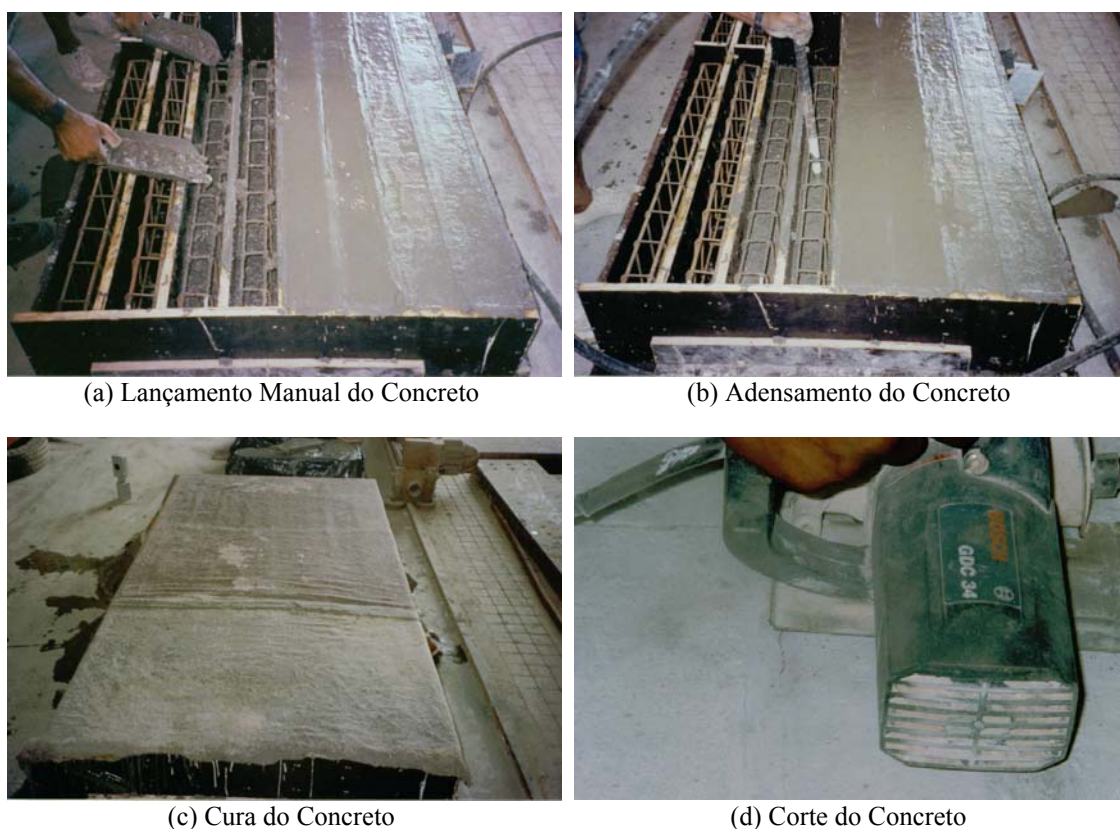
Concretagem e Execução do Entalhe das Vigotas Ensaçadas
